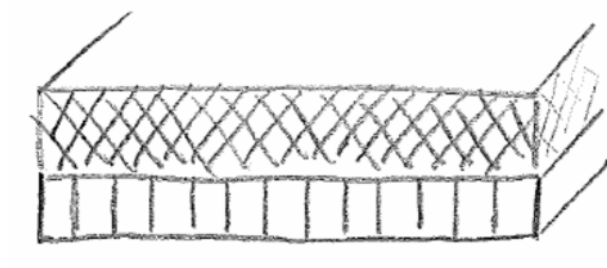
Holz-Beton-Verbund mit Buchenlamellen
